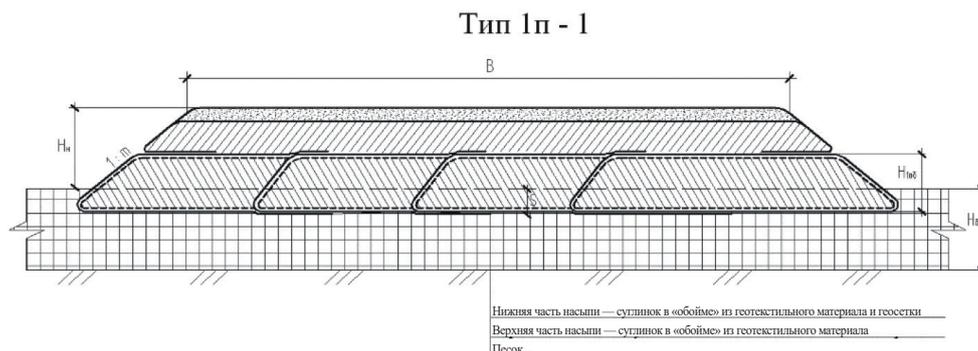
Конструкция земляного полотна на площадках шириной более 25 м
